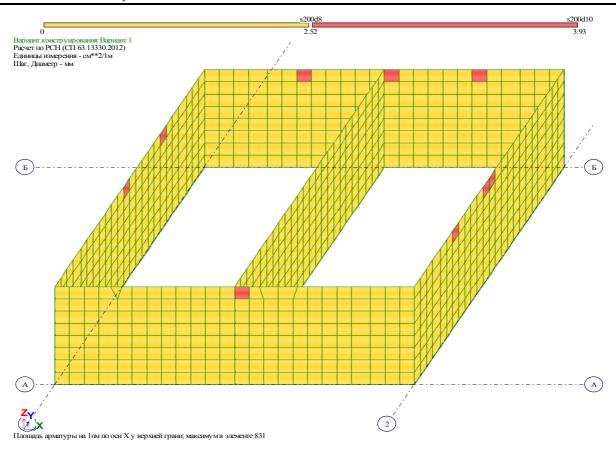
Площадь армирования по внешней грани стен по оси X (рабочие швы бетонирования отсутствуют)
